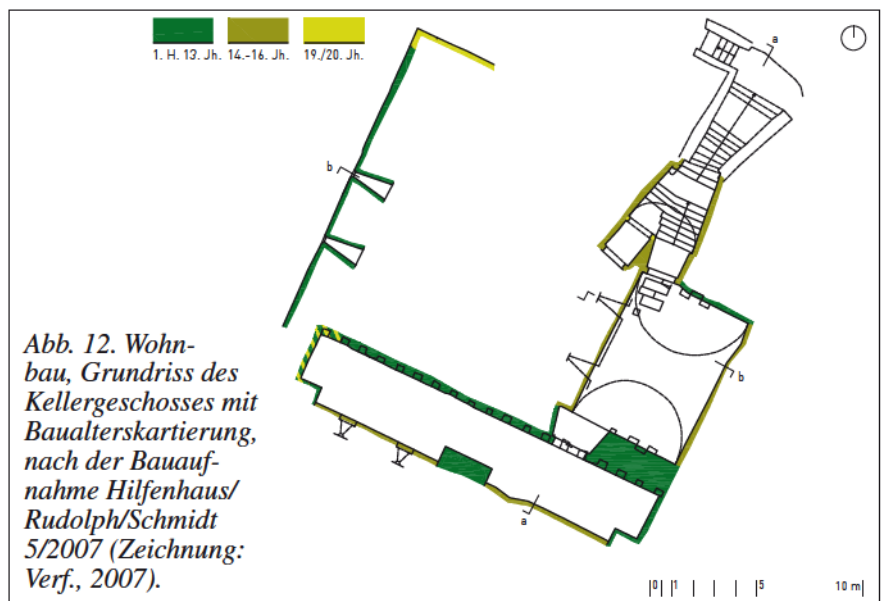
Wohnbau, Grundriss des Kellergeschosses mit Baualterskartierung, nach der Bauaufnahme Hilfenhaus/Rudolph/Schmidt 5/2007 (Zeichnung: Verf., 2007).
